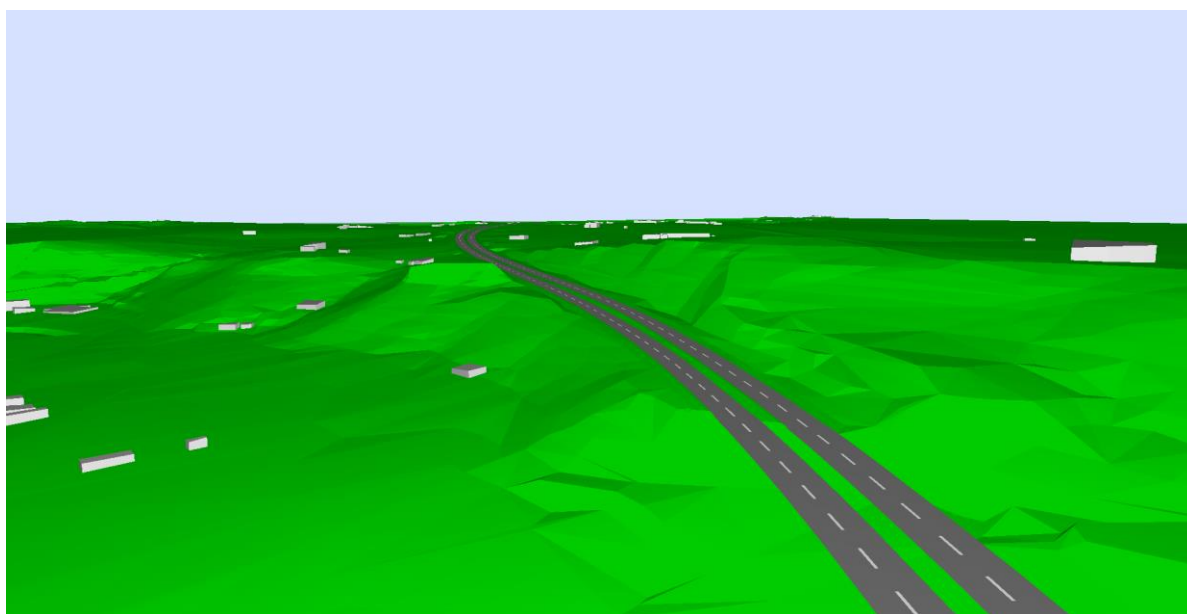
Modelo digital do terreno construído com base nos elementos cartográficos, já com a Via do Infante implantada - vista sobre a zona da Machada, junto ao pK 1+000.
